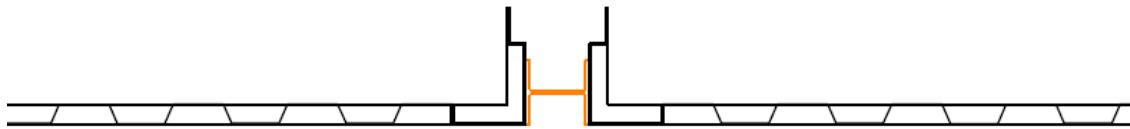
Utilização de Perfil HEB como ligação entre contentores, vista em planta
